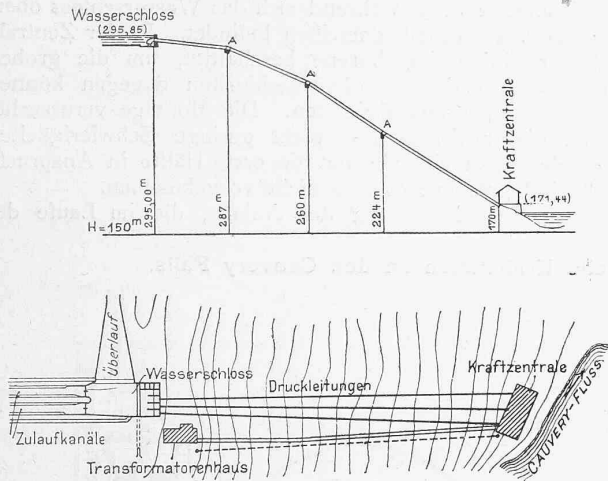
Längensprofil und Lageplan der Druckleitung.
